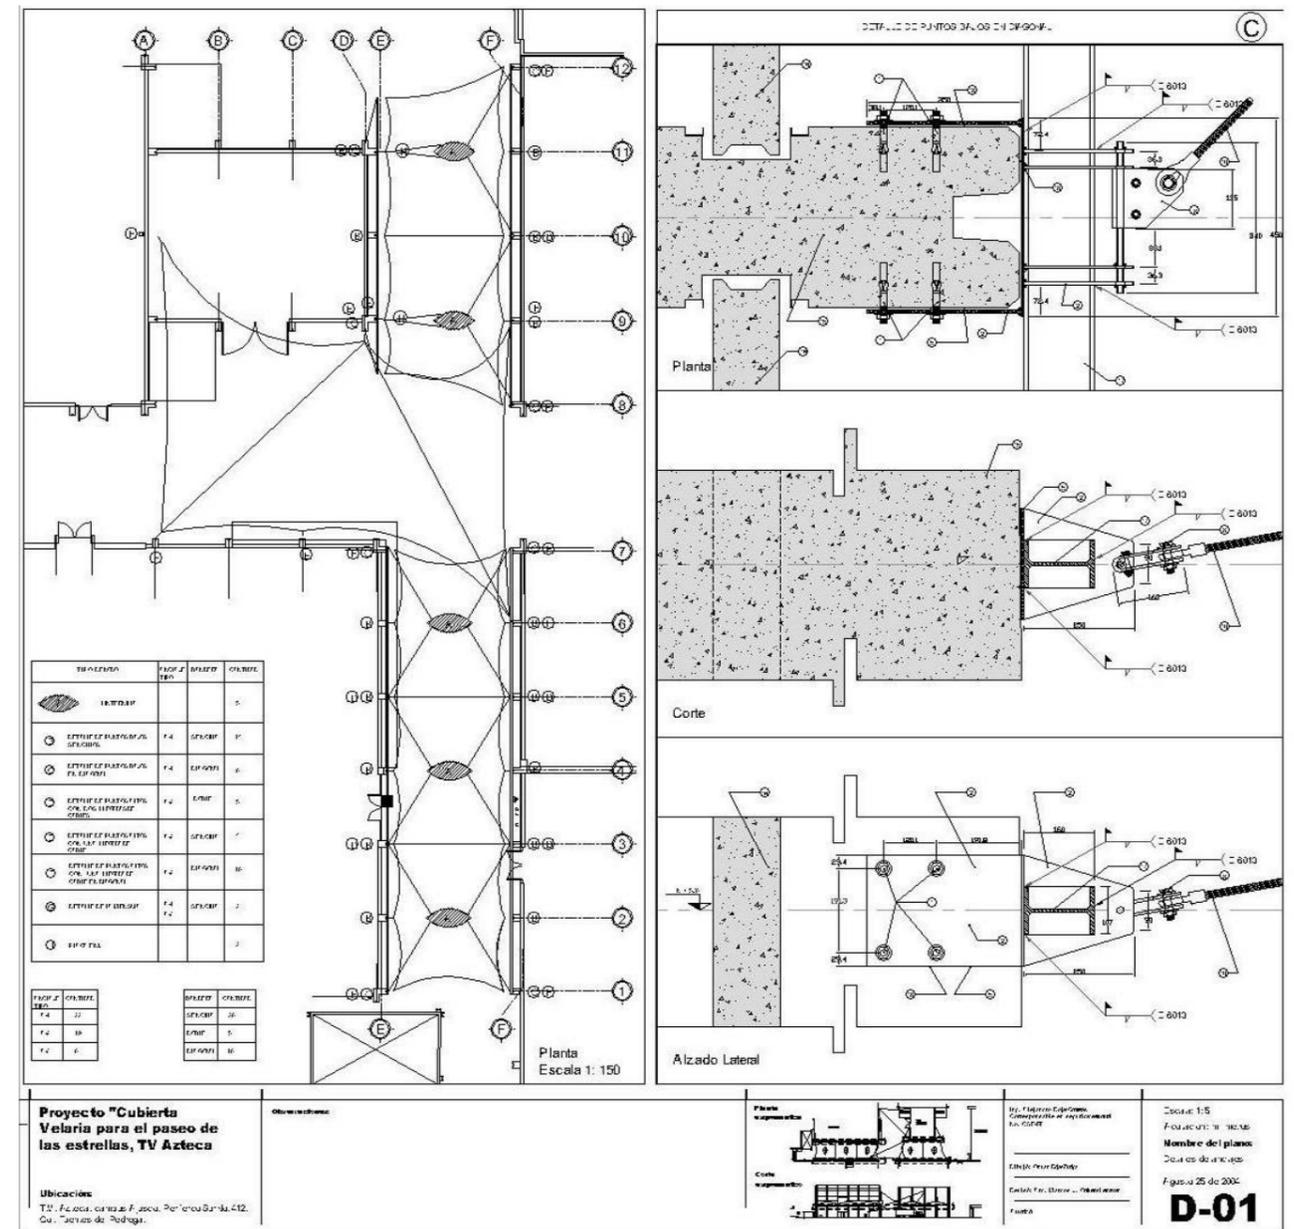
PLANO DE ANCLAJES A COLUMNAS EXISTENTES
